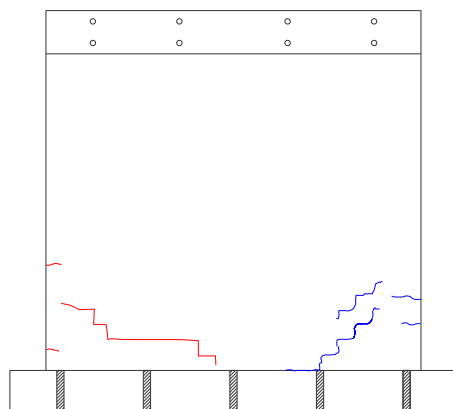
Ninguna reparación en muro de albañilería confinada con ladrillos pandereta industrial en la distorsión 1/3000.
